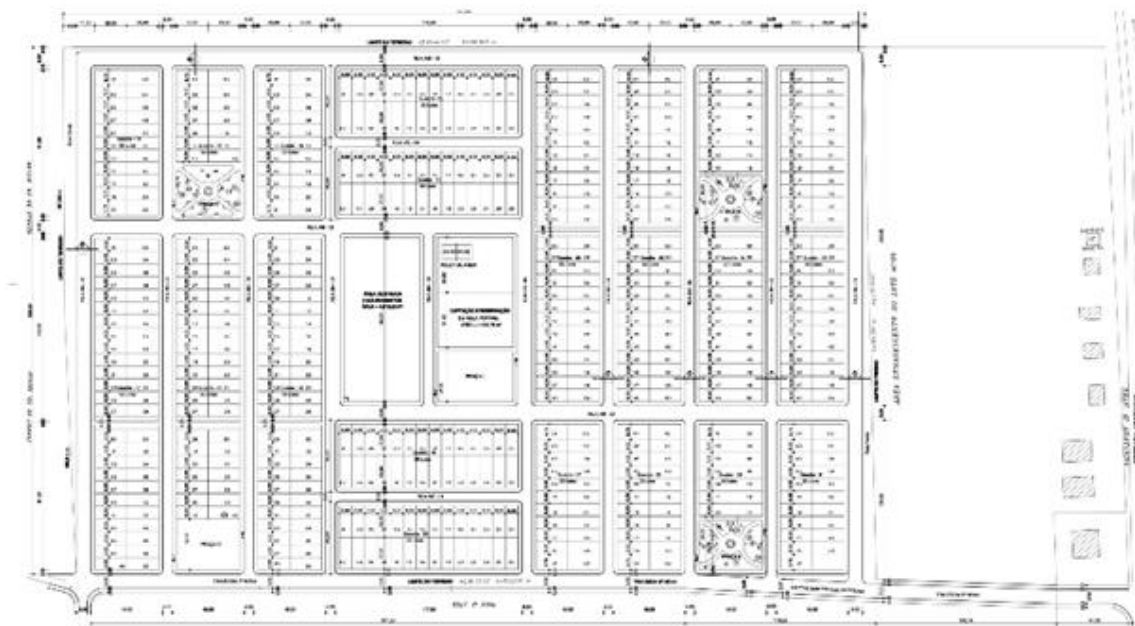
Planta do projeto do residencial Jardim das Garças, Santa Isabel do Pará. Fonte: COHAB/PA, 2007.
